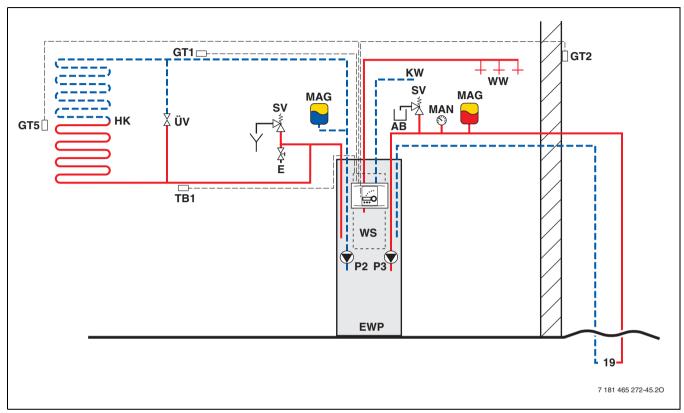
Heizungsanlage mit 1 Heizkreis und Warmwasserbereitung
